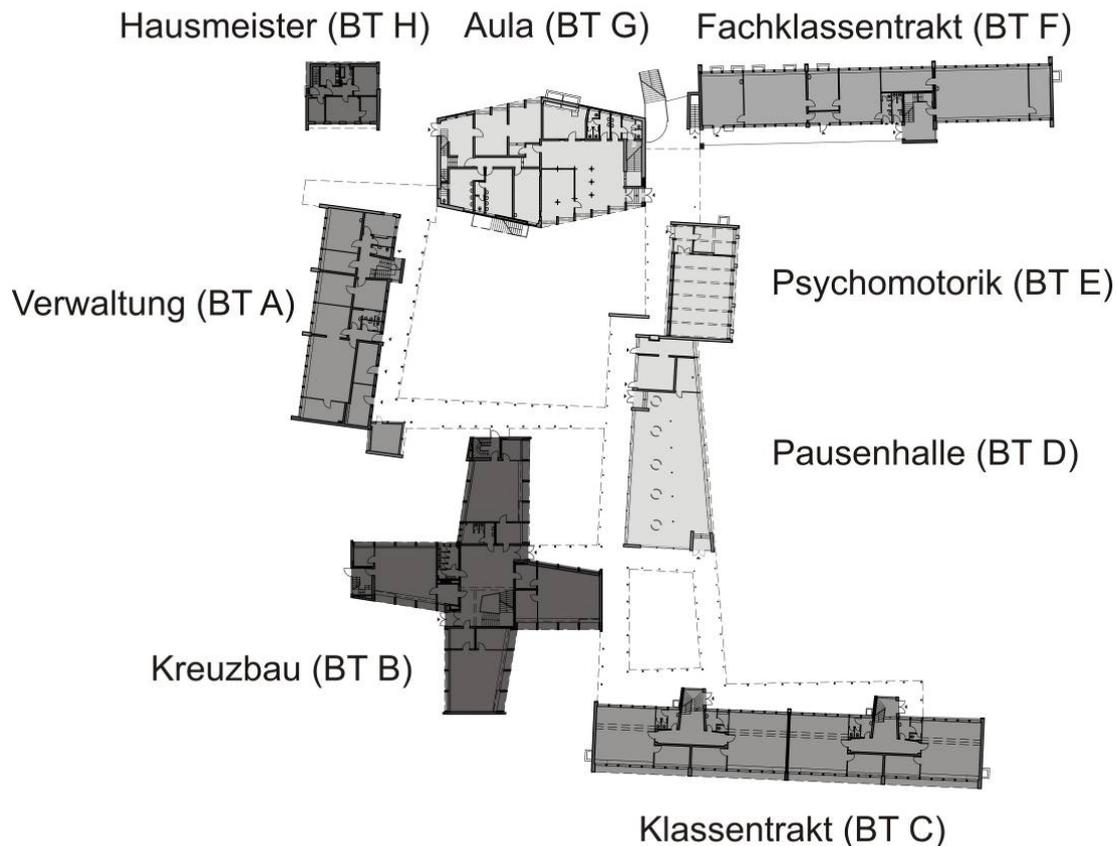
Grundriss EG, Grundschule Hamburg
